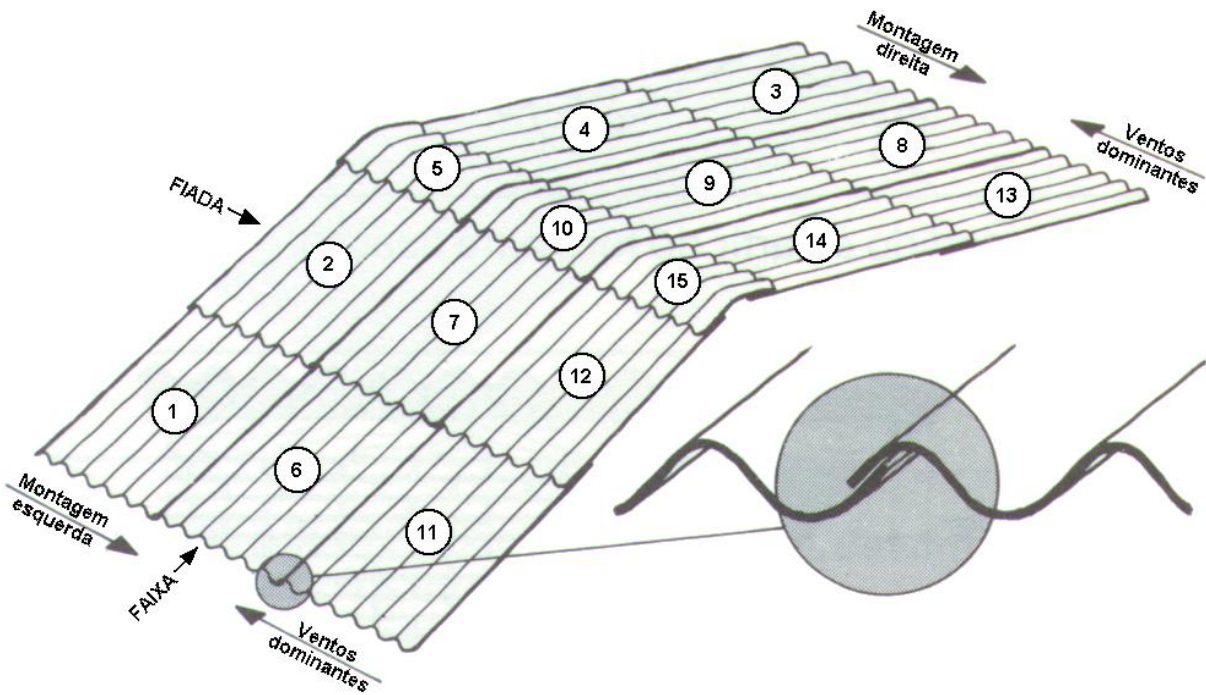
Montagem de um telhado, com telhas de fibrocimento modelo “Ondulada”
